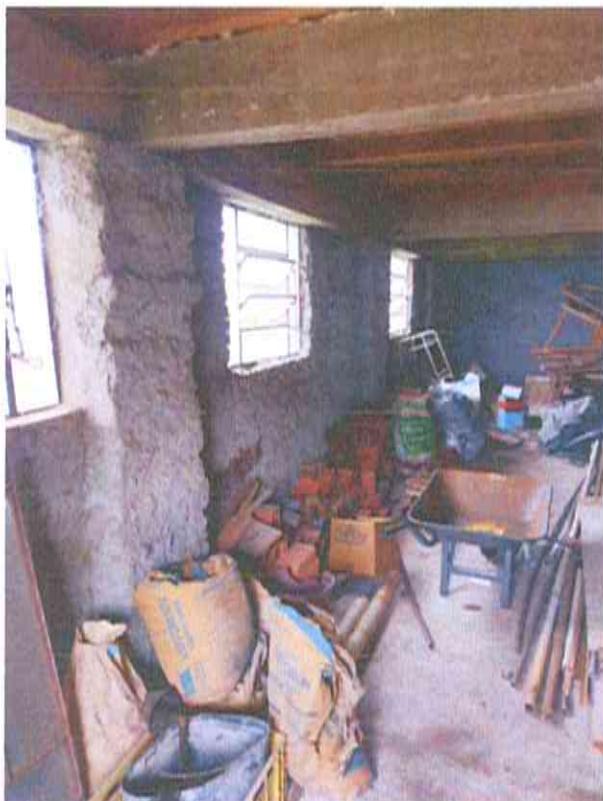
FOTOS DA EDIFICAÇÃO - INTERIOR DO PAVIMENTO TÉRREO
